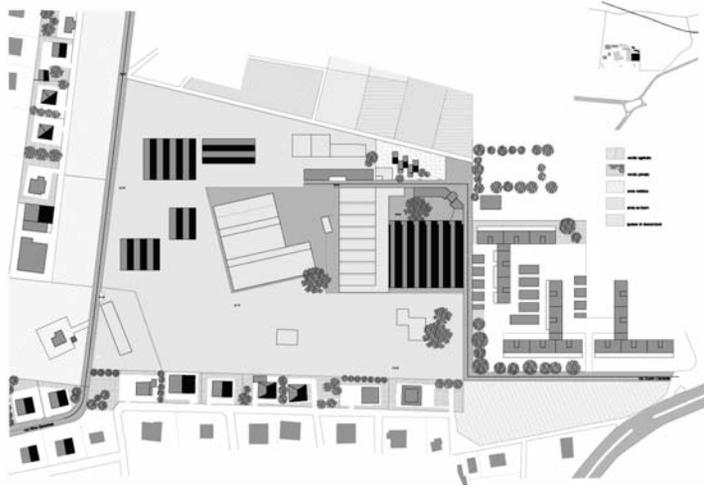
Planimetria generale dell'area dismessa intorno alla fabbrica, stato di fatto
